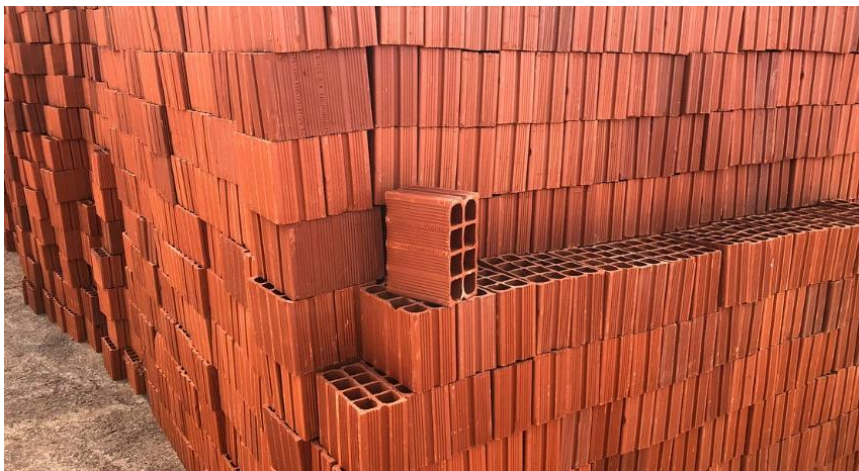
Pilha de bloco cerâmico (Fonte: Próprio autor)
